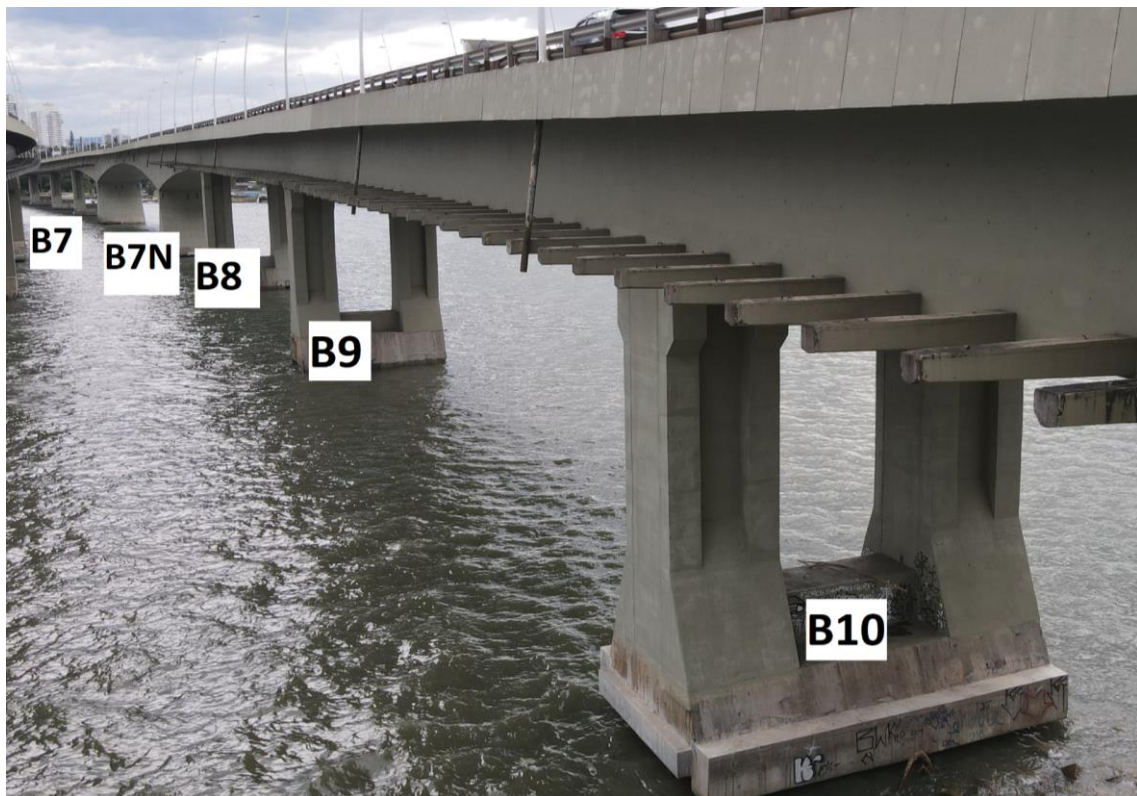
Vista da ilha: indicação dos blocos e da configuração das vigas remanescentes da passarela
